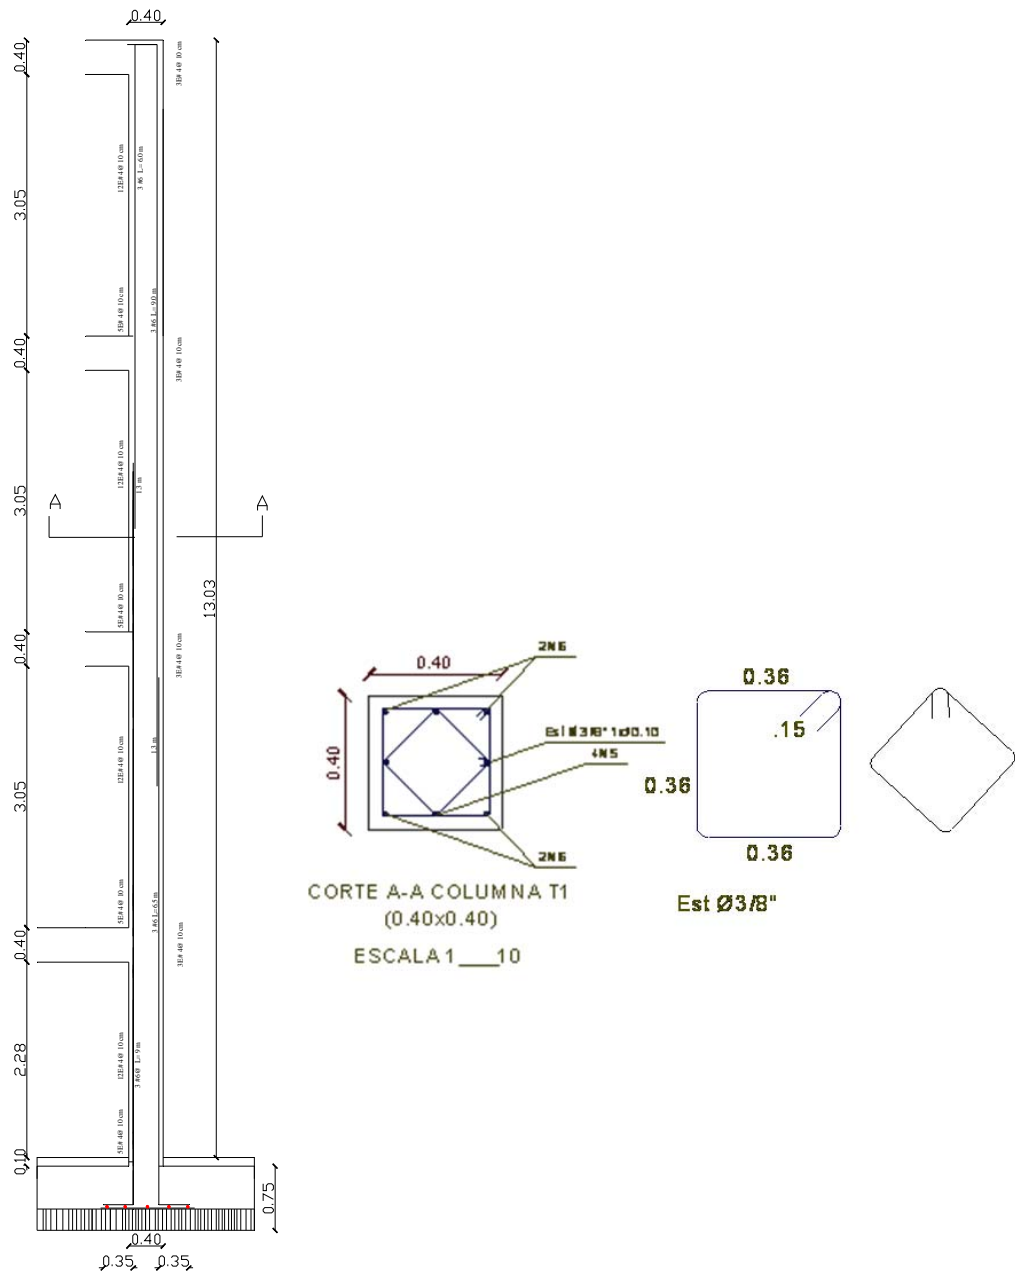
Despiece Longitudinal y Transversal de las Columnas.
